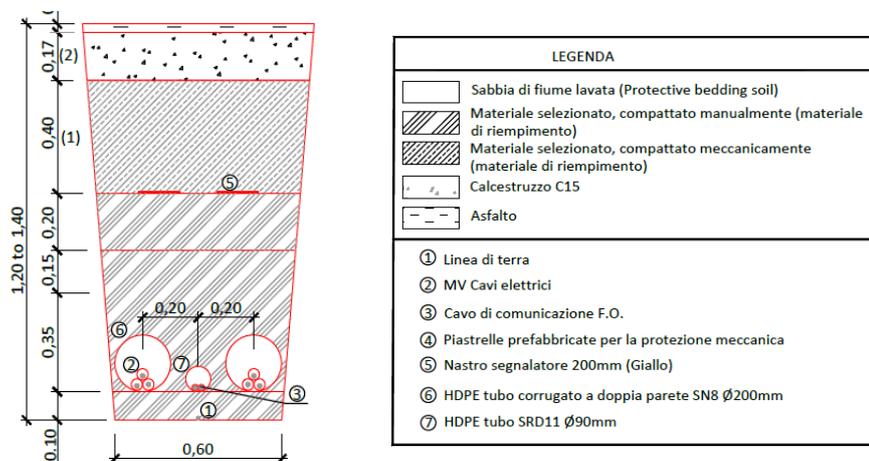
Sezione tipo cavidotto su viabilità pubblica
